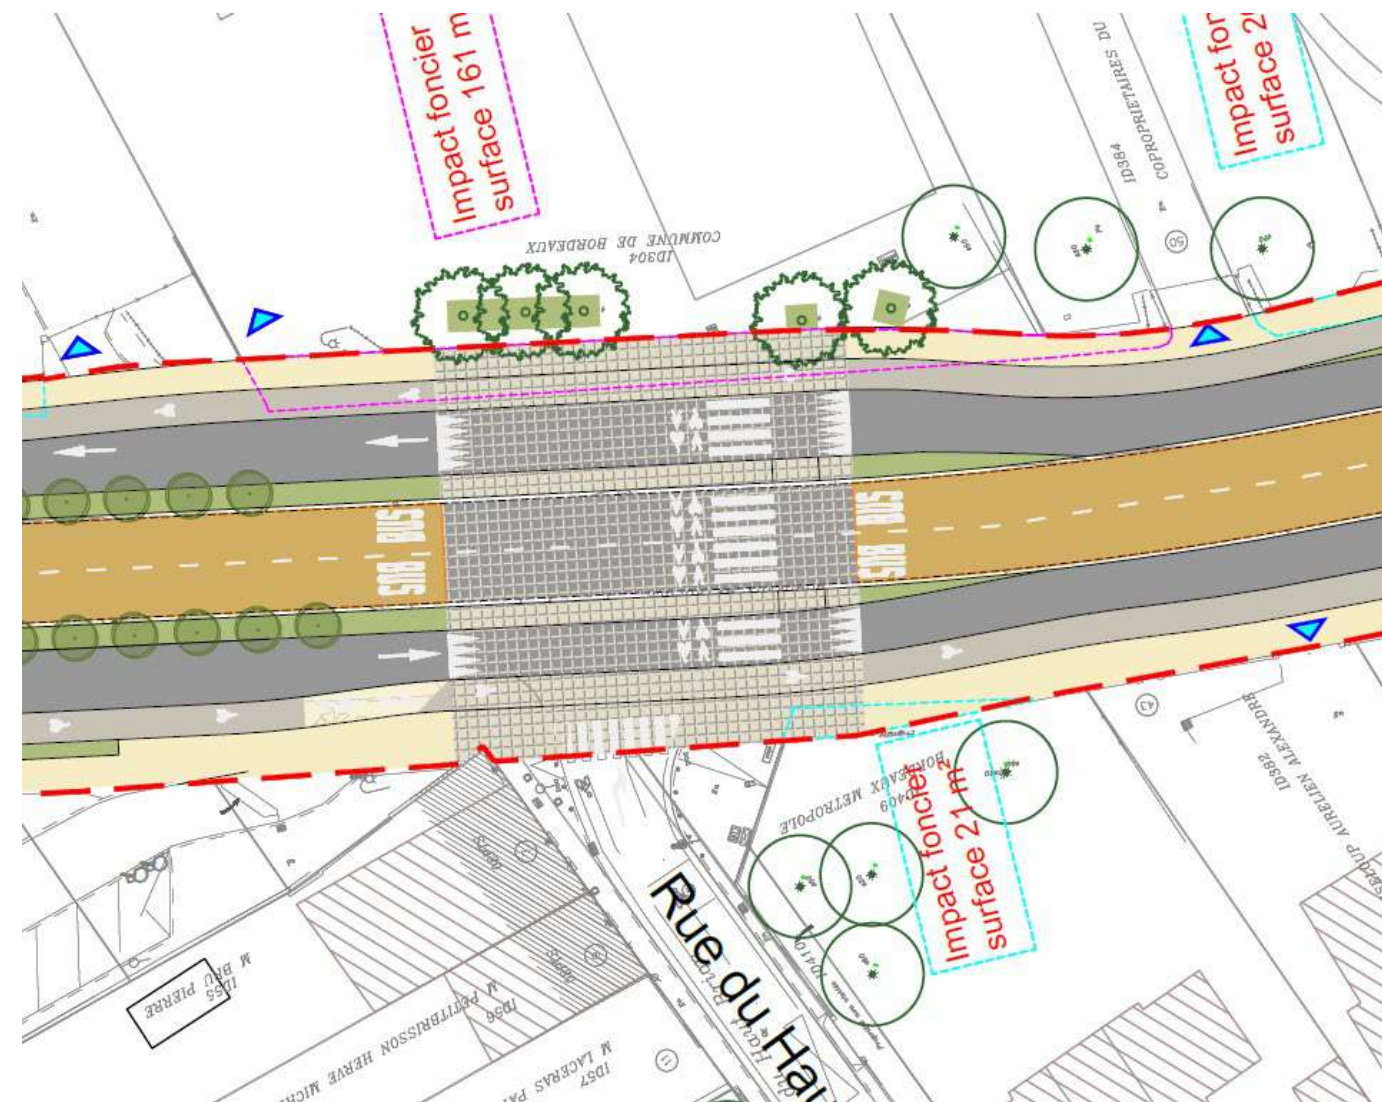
Plan AVP du carrefour Tauzin / Haut-Brion
